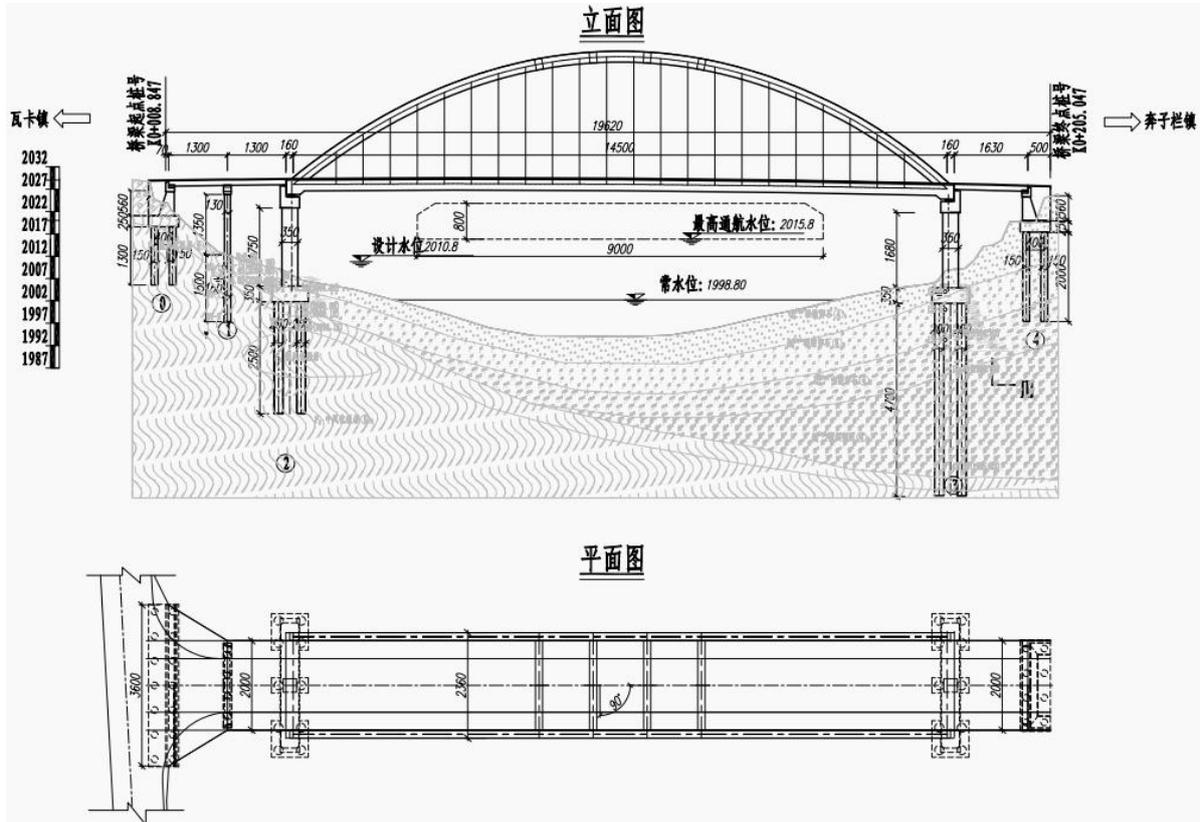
瓦卡金沙江大桥平、立面布置图
